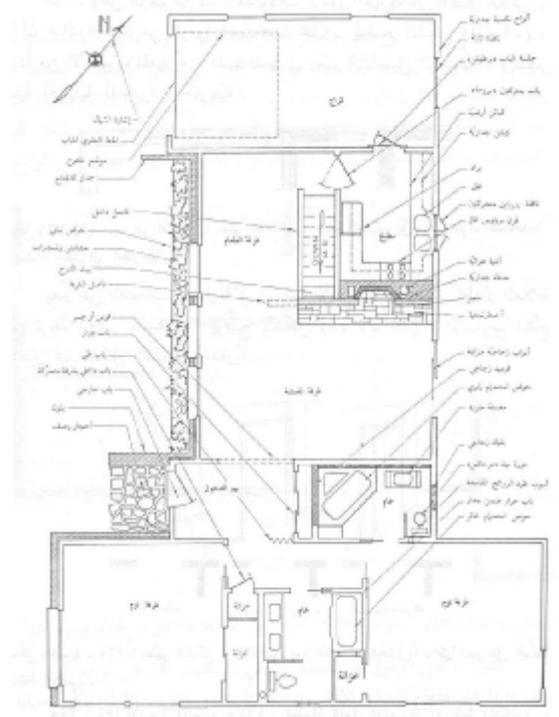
يظهر رسم مسقط أفقي بمنظور عين الطائر
